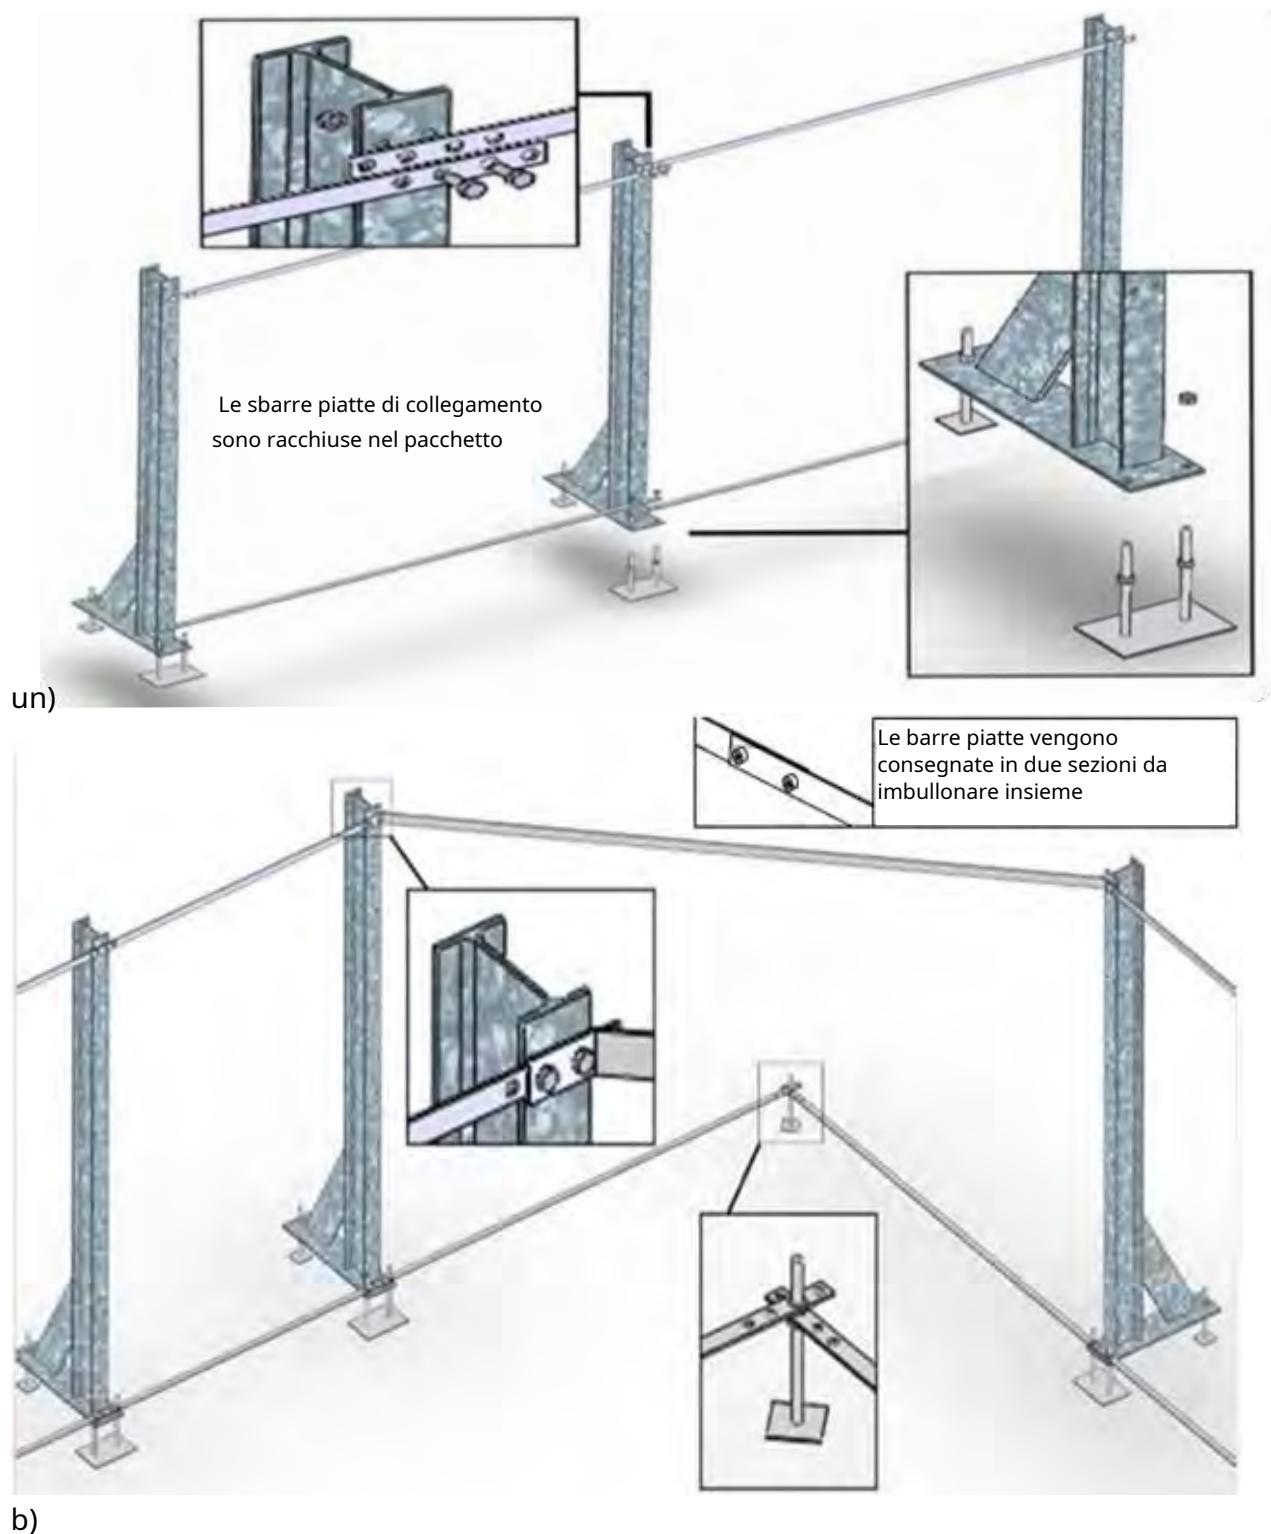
aeb - Assemblaggio delle barre piatte sui controventi
